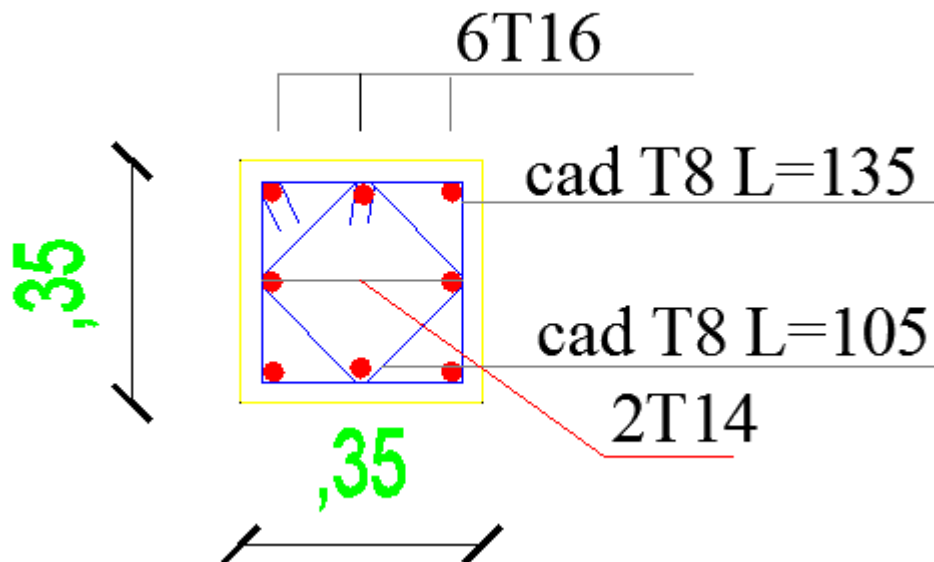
Vue en plan du ferrailage des armatures du poteau ( 35 × 35 )
